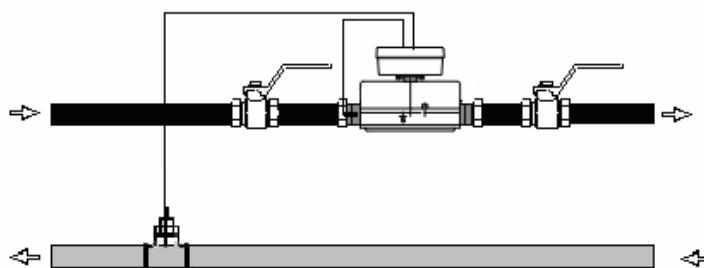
Схема установки (вариант монтажа расходомера на подающем трубопроводе)
